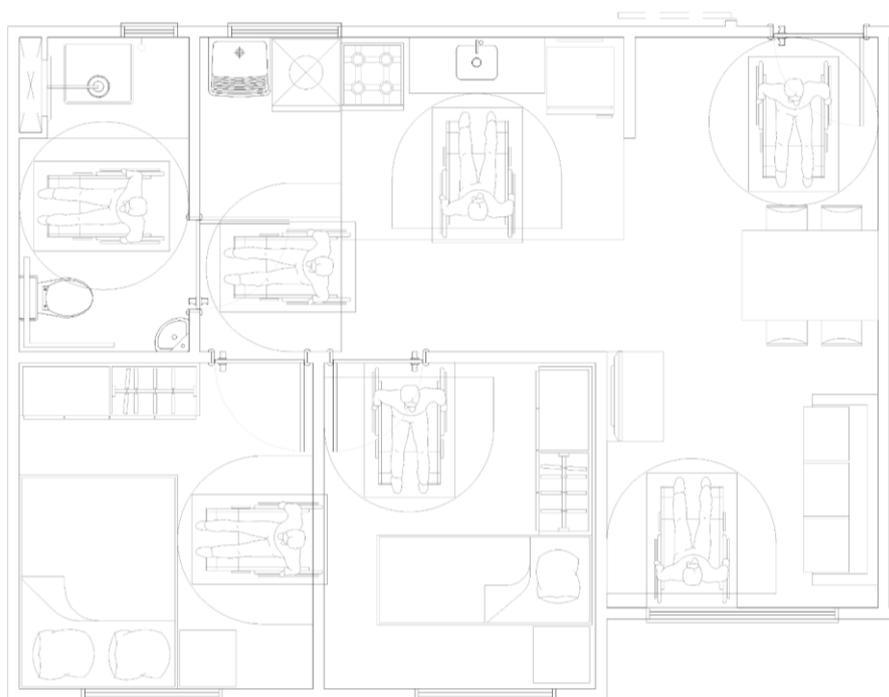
Layout para apartamento acessível de 44,50m<sup>2</sup> disponibilizado pela construtora
